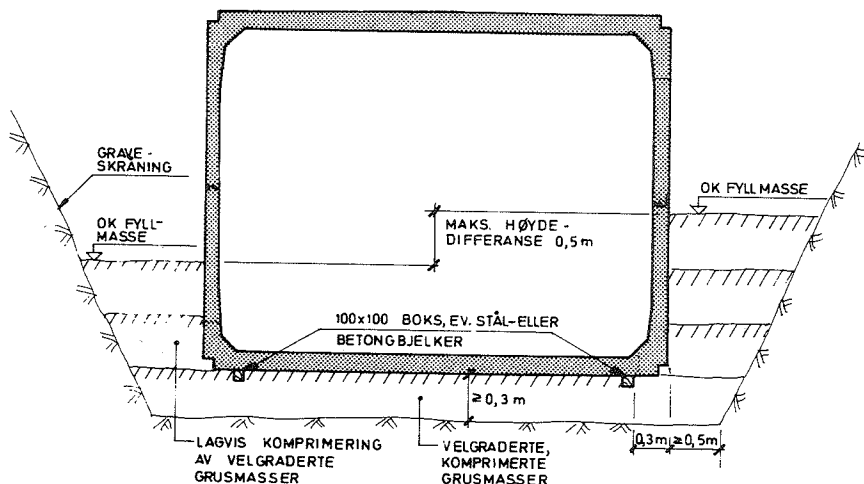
Elementkulvert på ikke telefarlige masser
